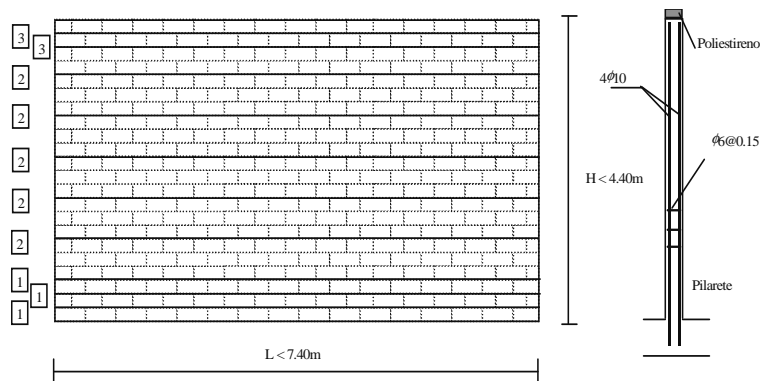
Paredes de acesso às instalações sanitárias: (a) solução alternativa adoptada e (b) modelo de cálculo.
